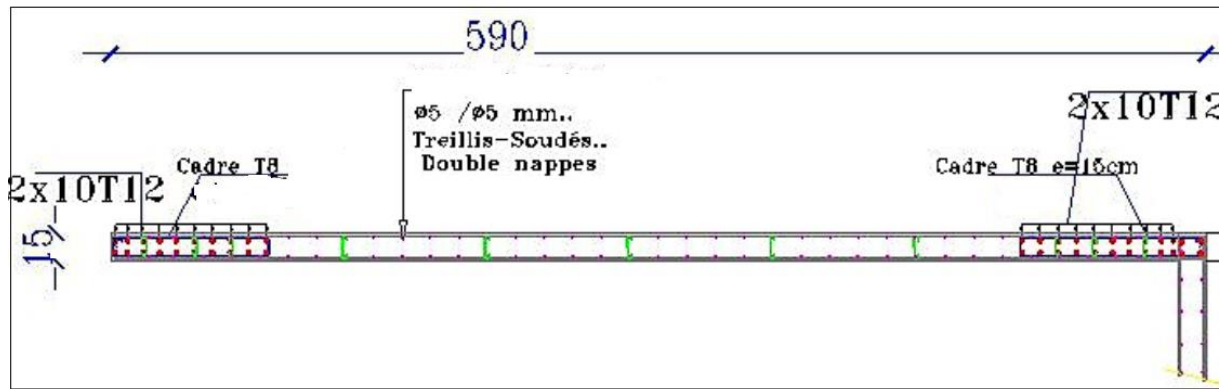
Ferrailage des voiles ue en plan VY(16, 27).
